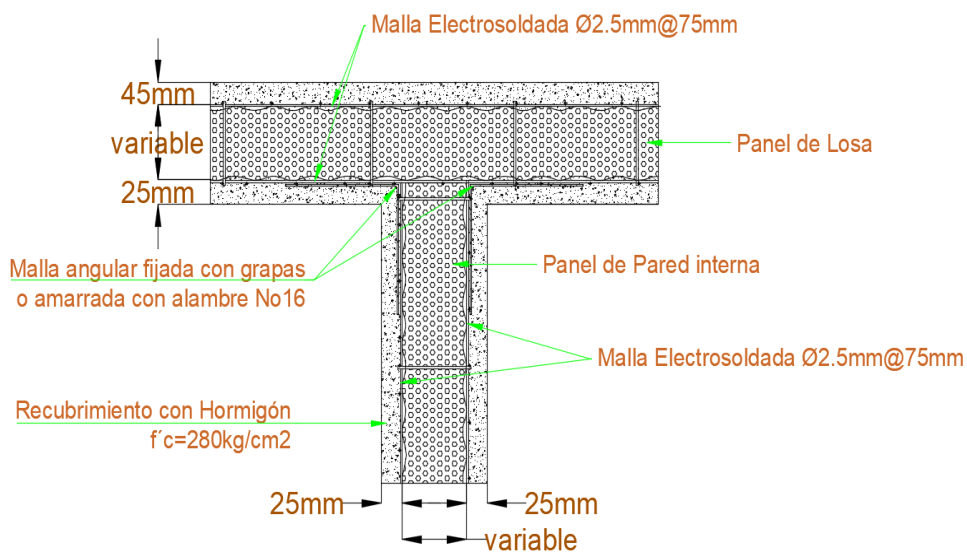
Detalle unión de panel de losa con panel de pared interna (ELEVACIÓN)
